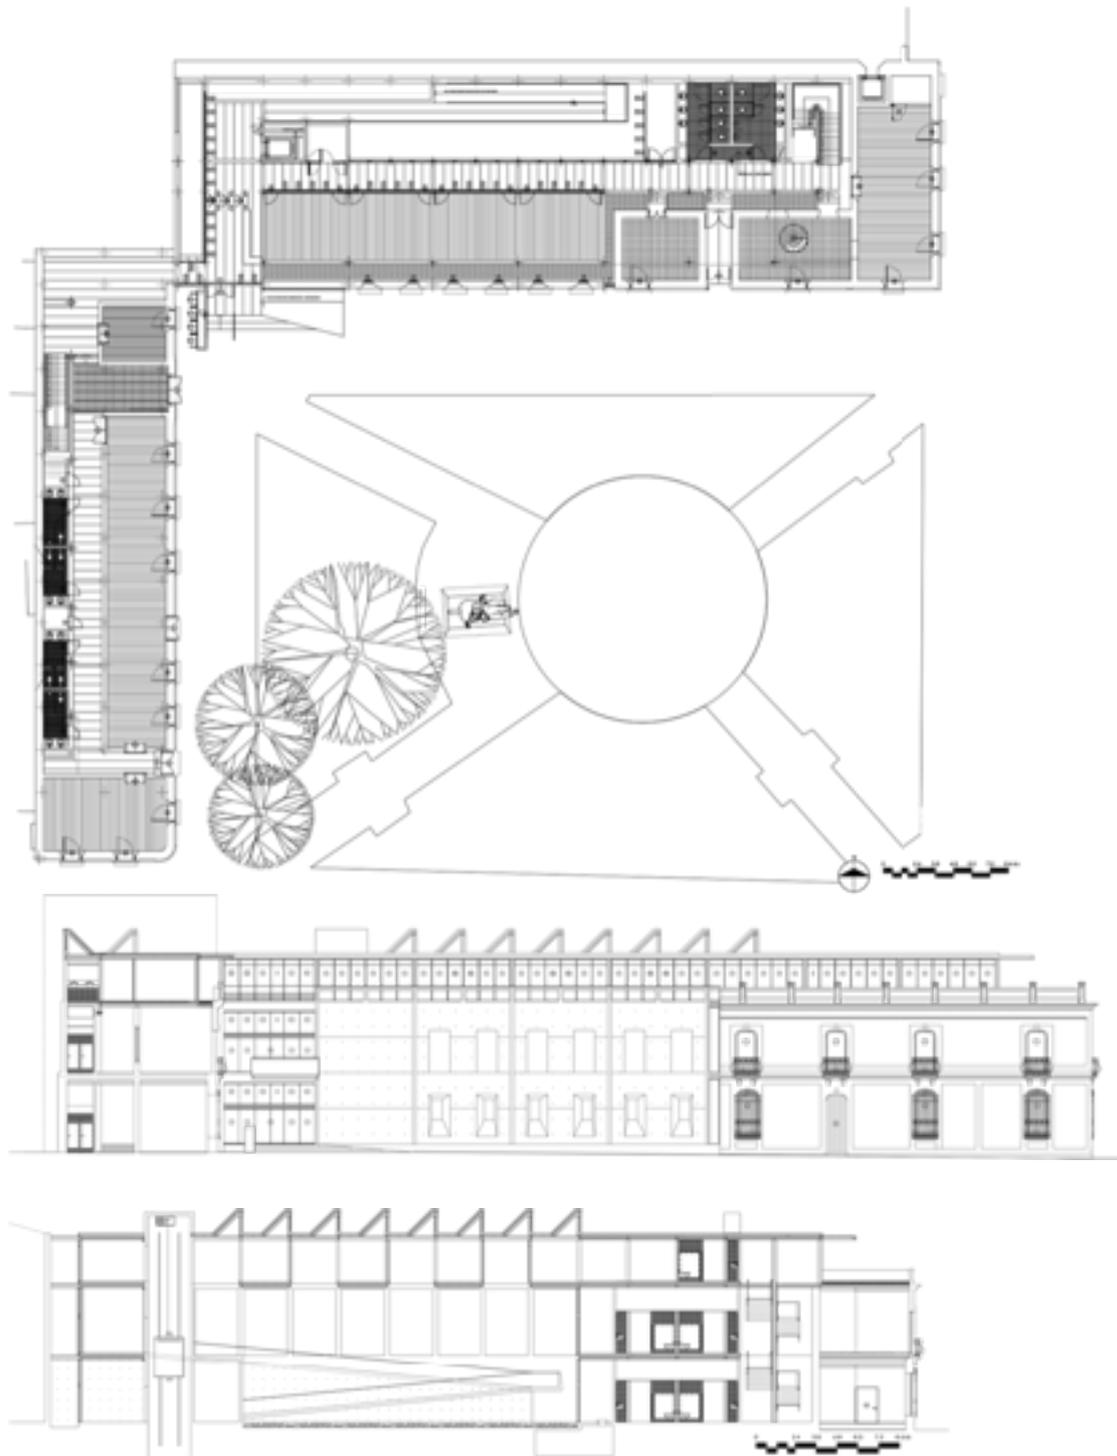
Plantas y secciones del proyecto de rehabilitación
